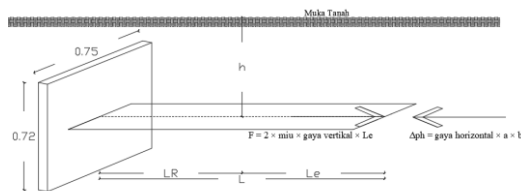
Desain panjang geotekstil yang digunakan dalam perencanaan I
